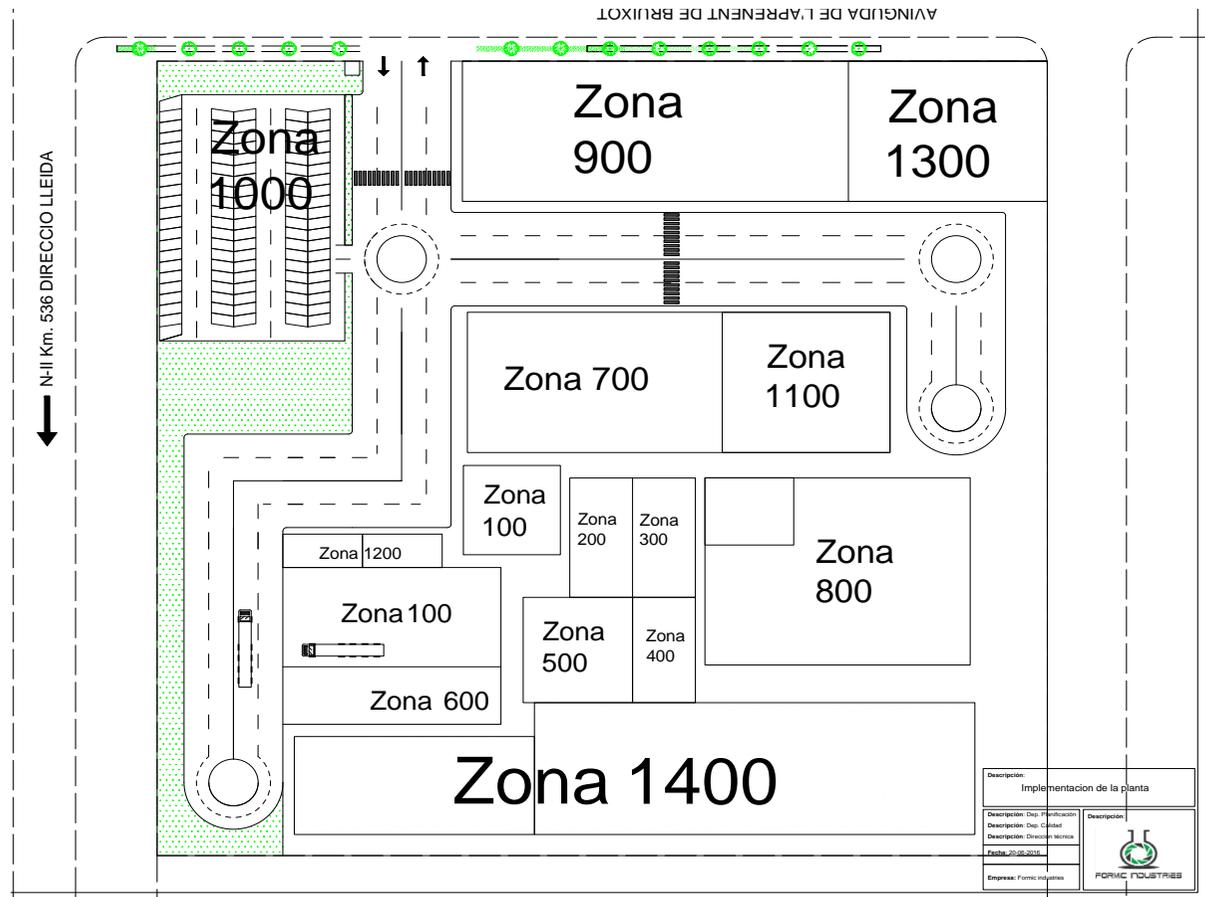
Plano de la planta con su correspondiente distribución por área
